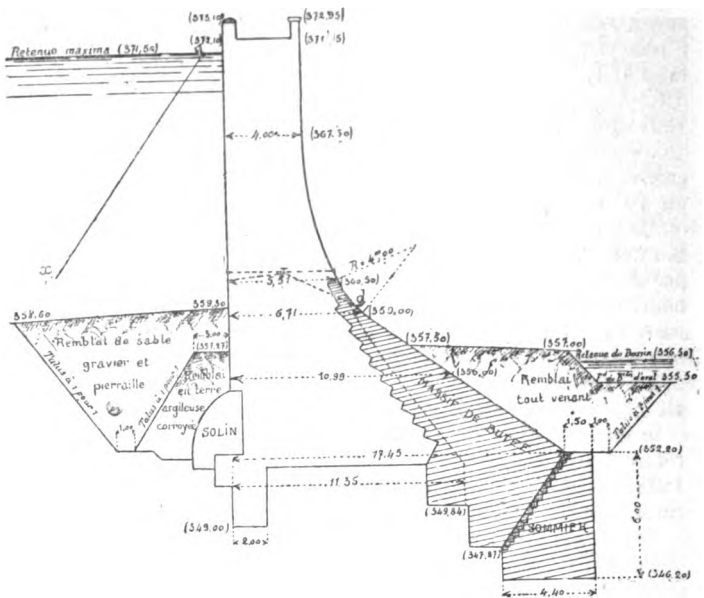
Coupe du barrage de Bouzey après sa consolidation.
